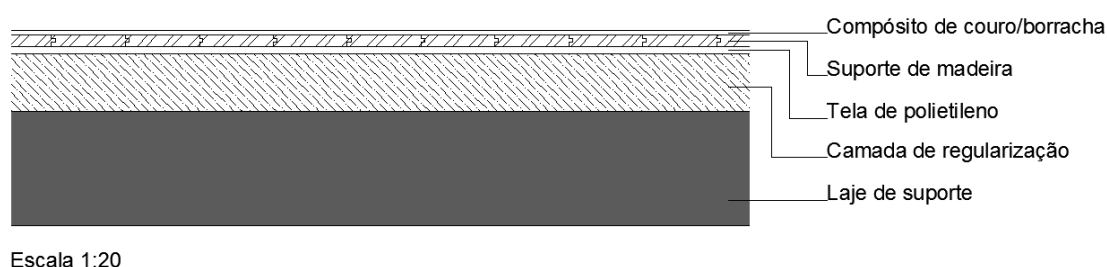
Detalhe construtivo de pavimento com revestimento com compósito couro/borracha
